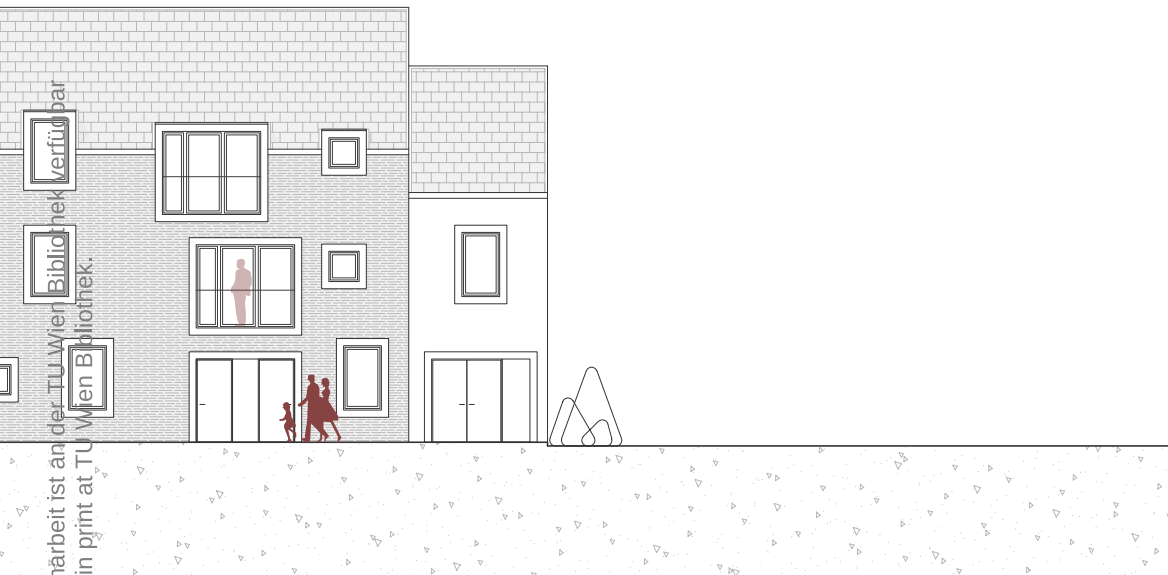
Entwurfsplan Schnitt B-B M 1:200
